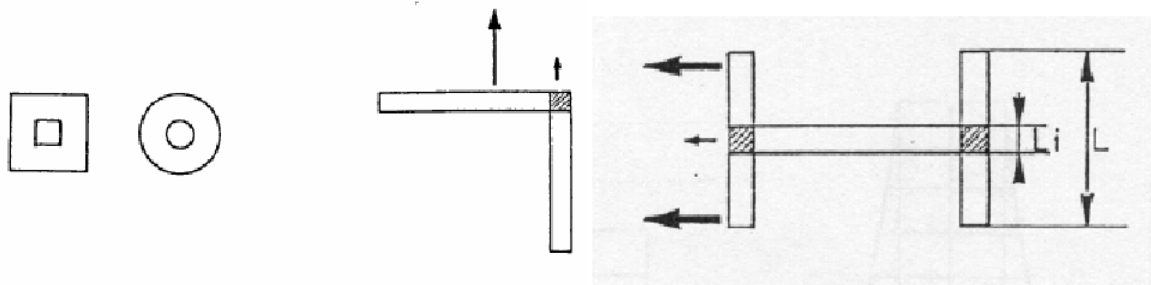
Vues en plan de bâtiments. A gauche : symétriques et compacts en plan.
